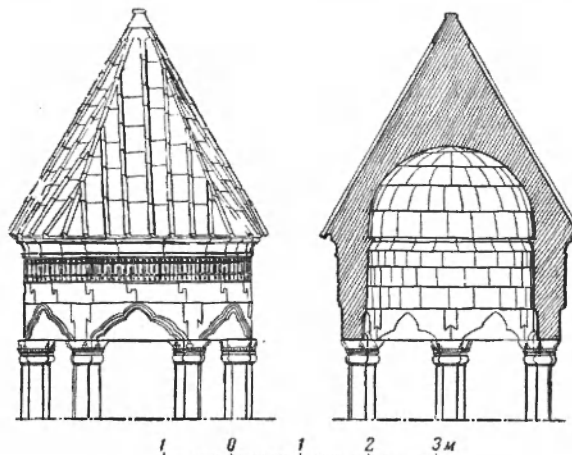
Фасад и разрез купола ротонды колокольни Санаина
